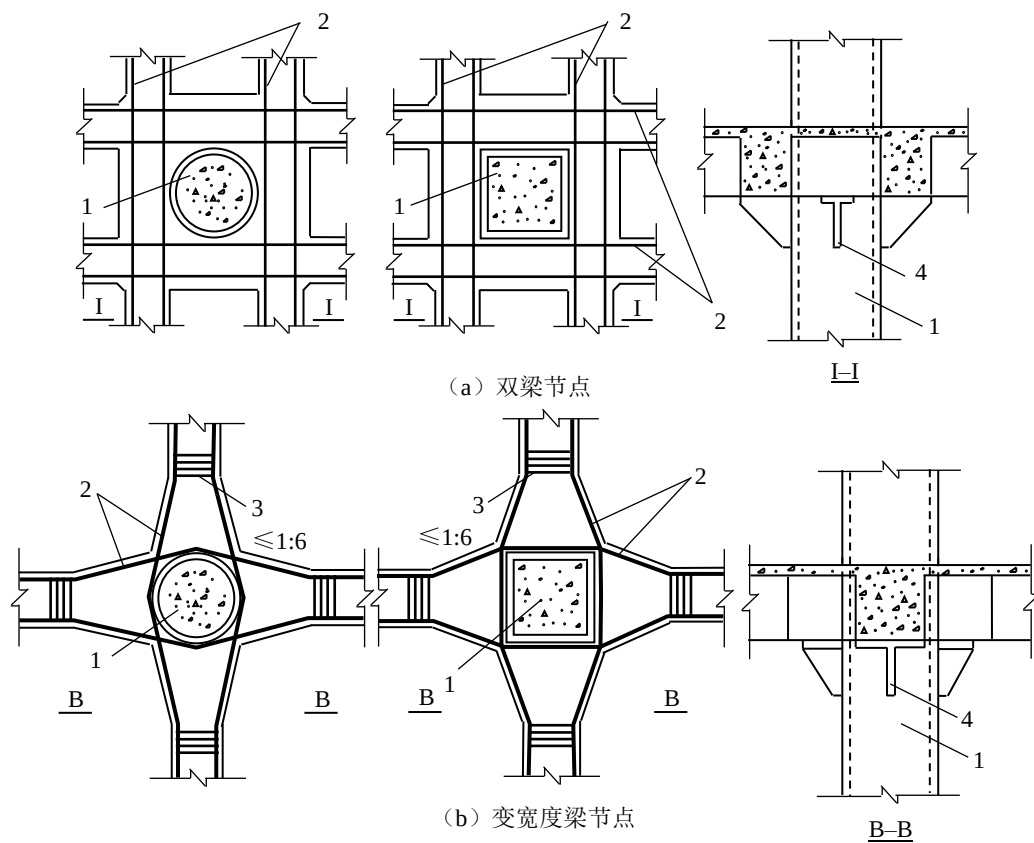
现浇钢筋混凝土梁节点示意图
